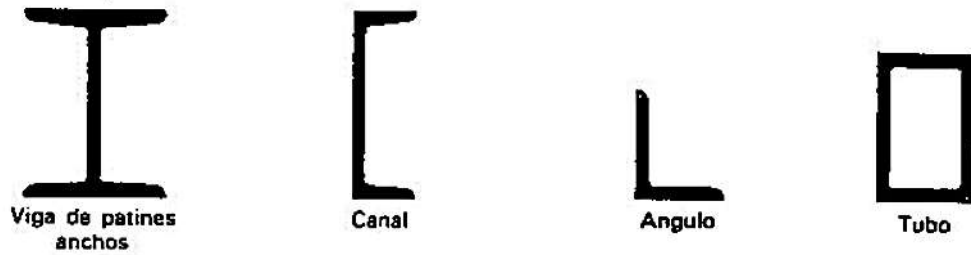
Ejemplos de sección transversal de elementos a tensión
